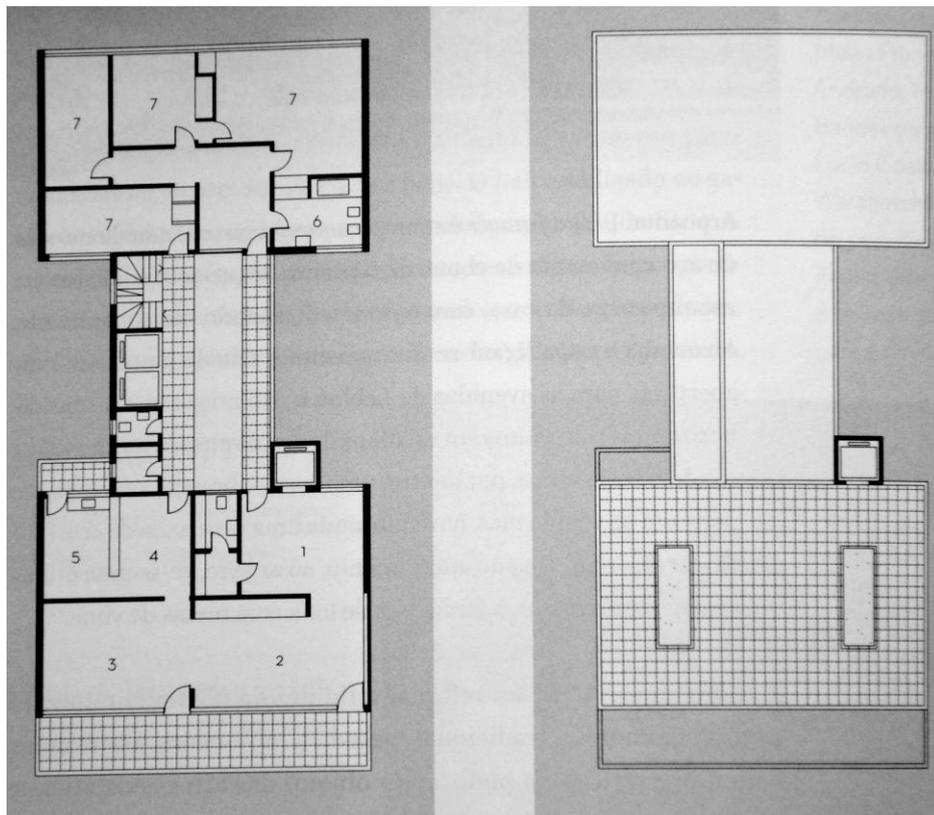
Convite e planta da Exposição de um Apartamento Moderno
